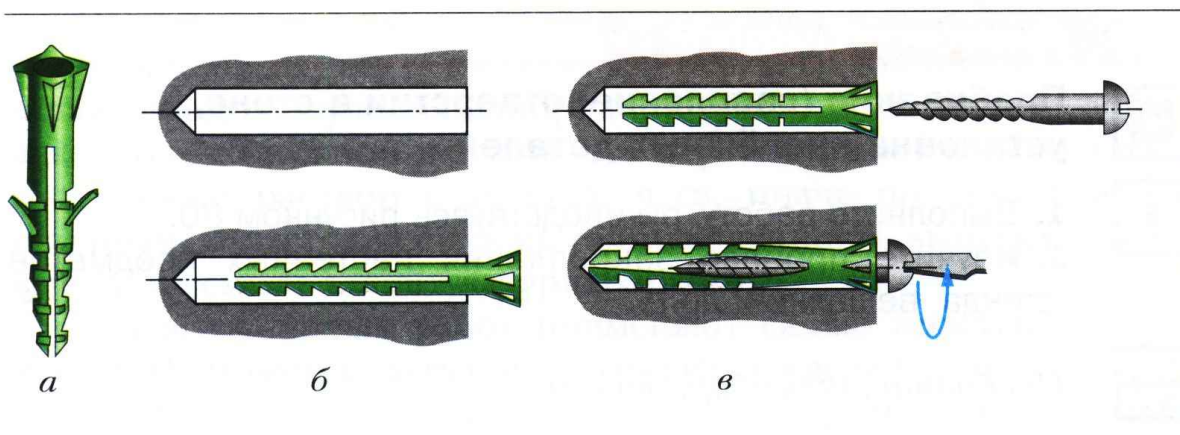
Внешний вид пластмассовой пробки (дюбеля) (а), её установка в отверстие (б) и завинчивание крепёжного шурупа (в)
